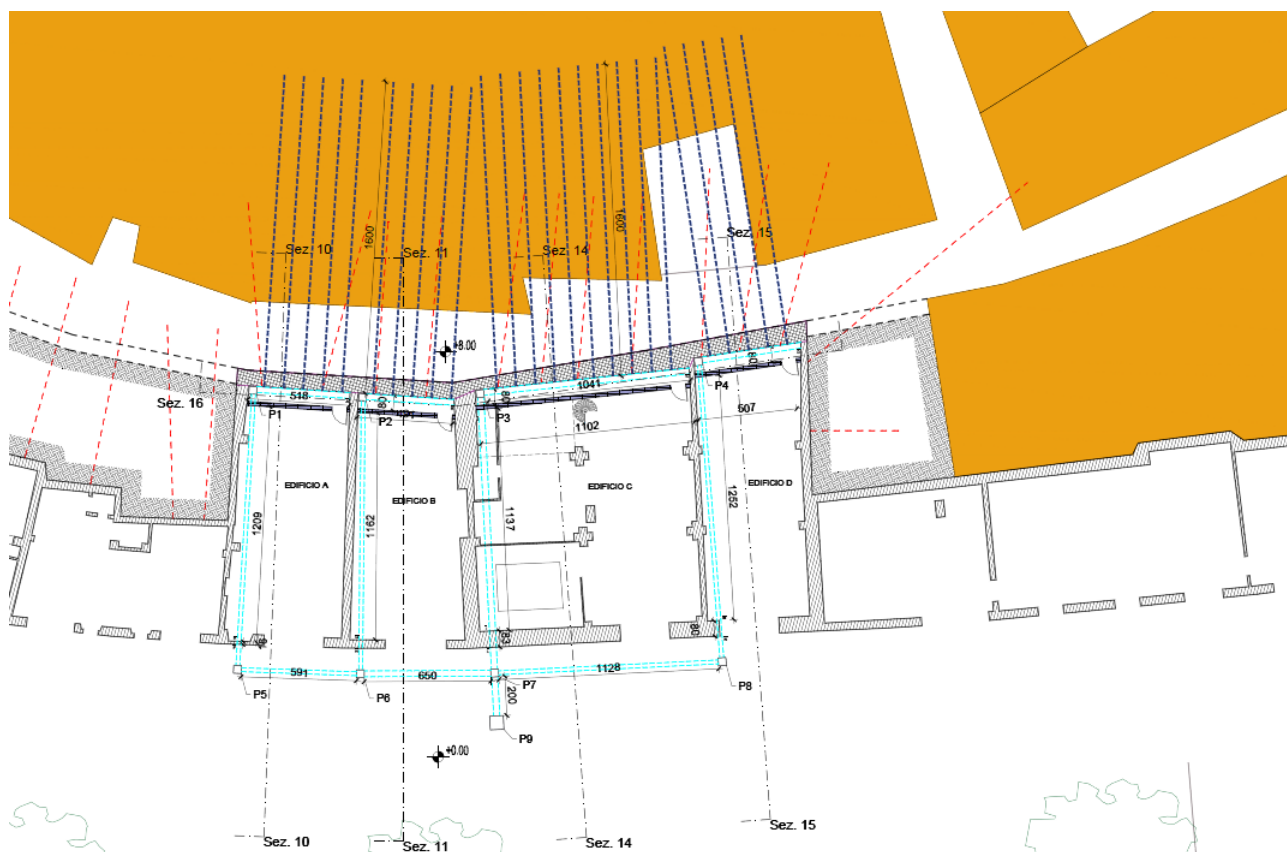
Stralcio della planimetria di progetto esecutivo primo lotto
